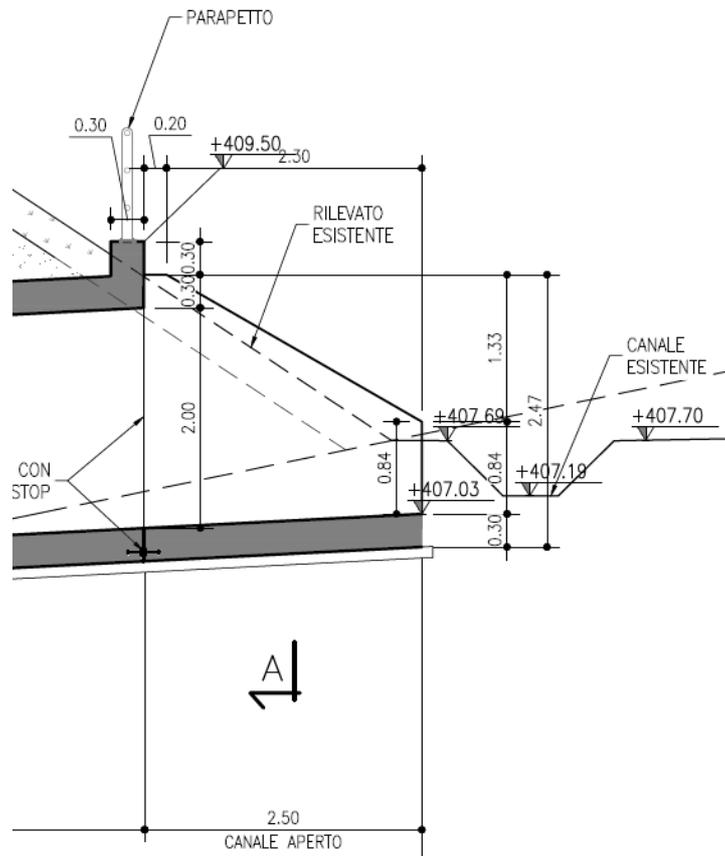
Muri d'imbocco - Sezione longitudinale
